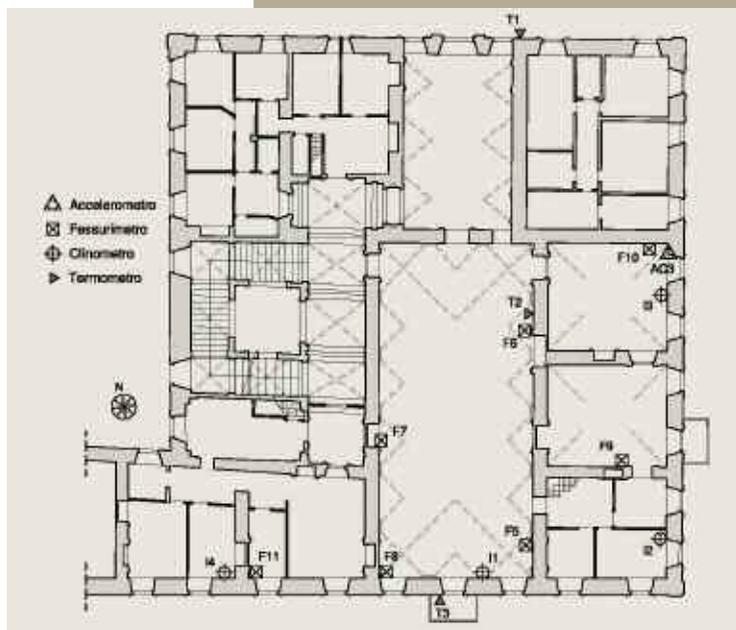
Pianta piano nobile - sistema di monitoraggio.
